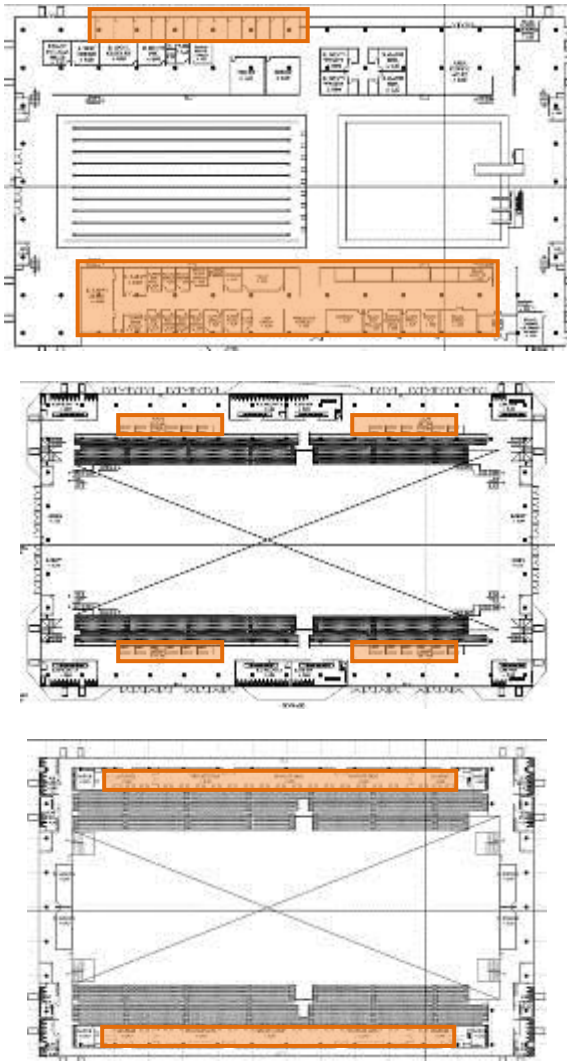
Denah Layoutplan. Sumber: penulis
